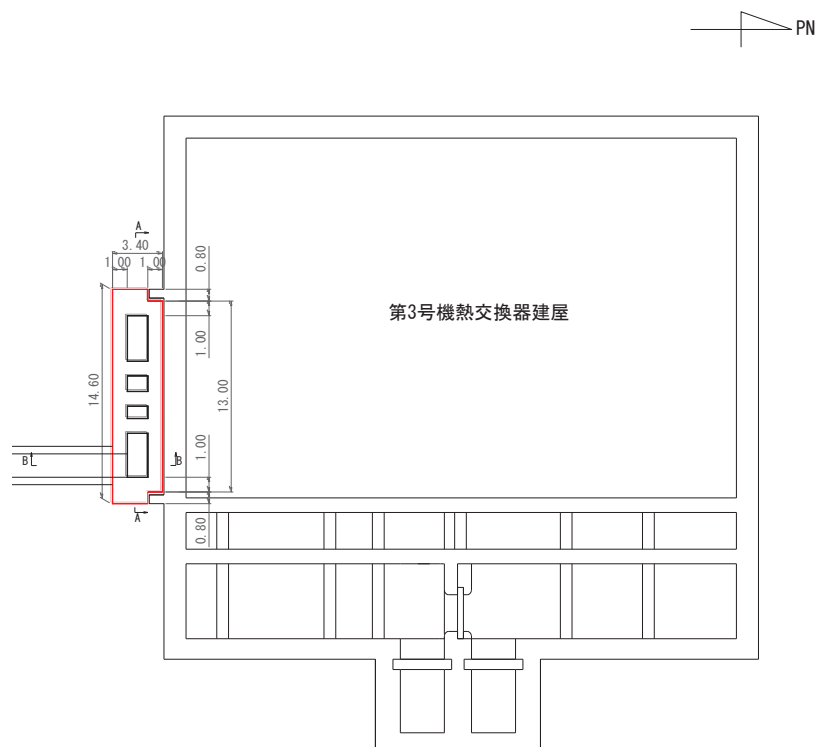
第 3 号機補機冷却海水系放水ピット平面図
